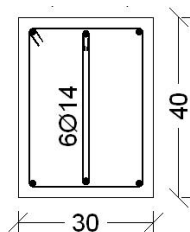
Coupe transversale d'une poutre type en béton armé.
